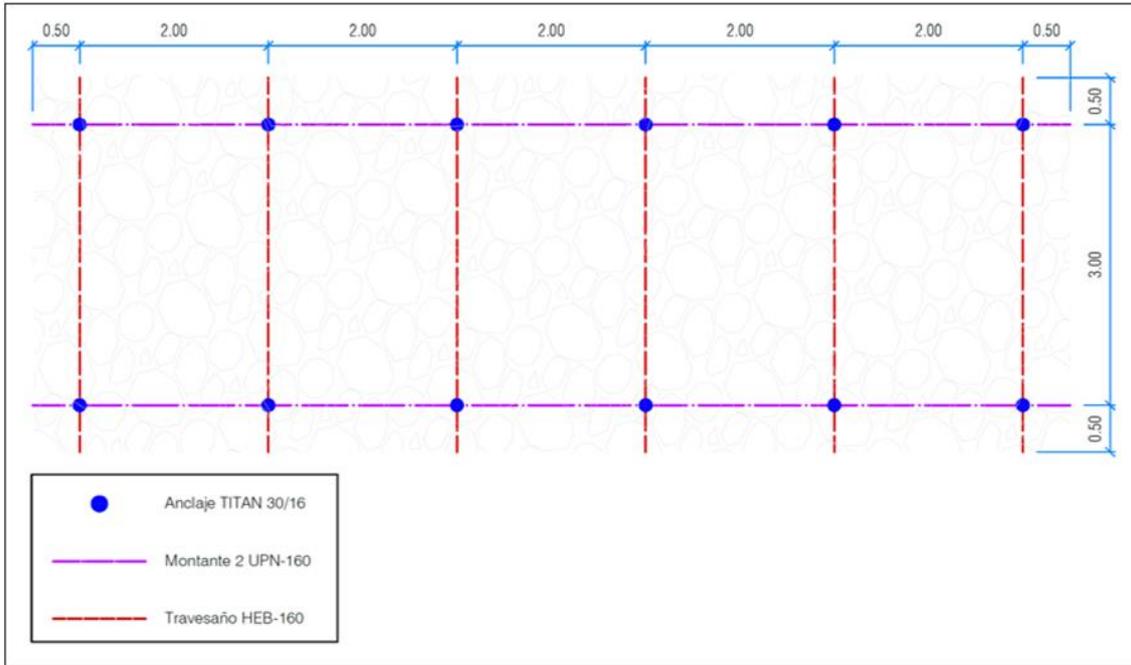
Sostenimiento planteado en el proyecto para el muro 4.
